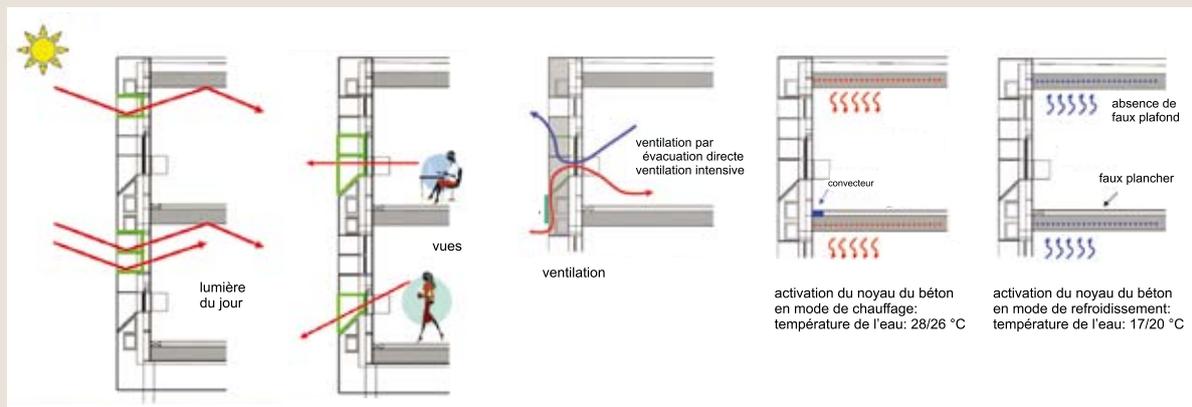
Façade intelligente et planchers en béton thermiquement activés (source : VK Engineering / Groupement belge du Béton)
